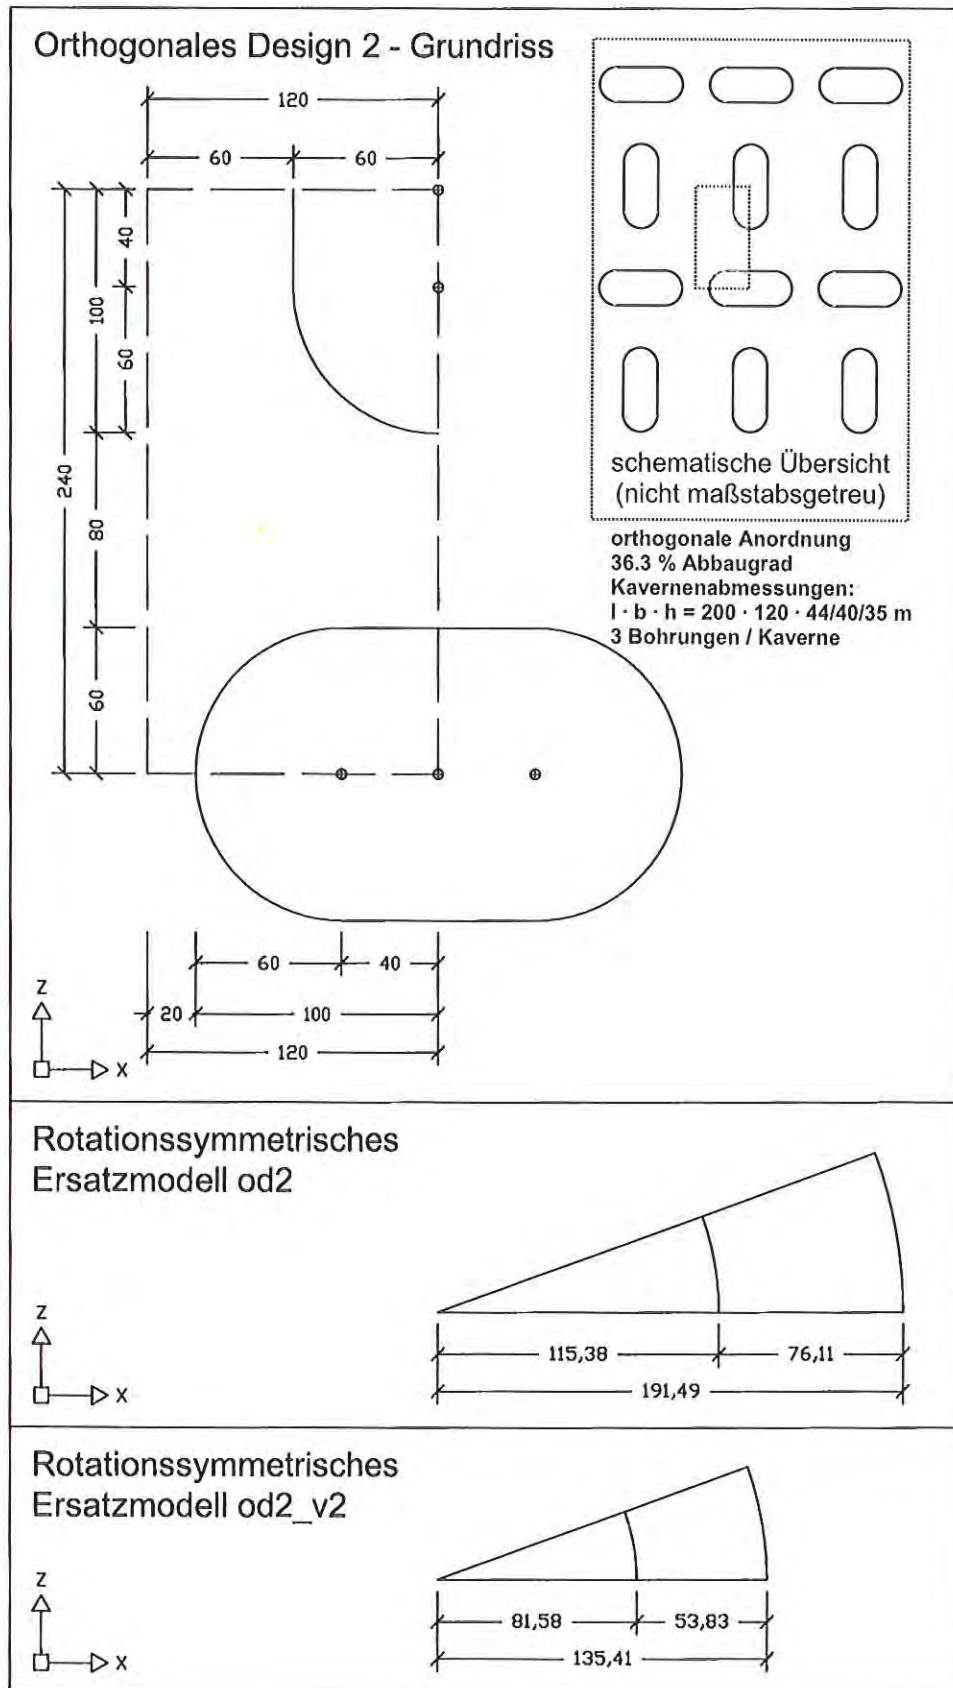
Orthogonales Design 2 – Grundriss und rotationssymmetrische Ersatzmodelle
